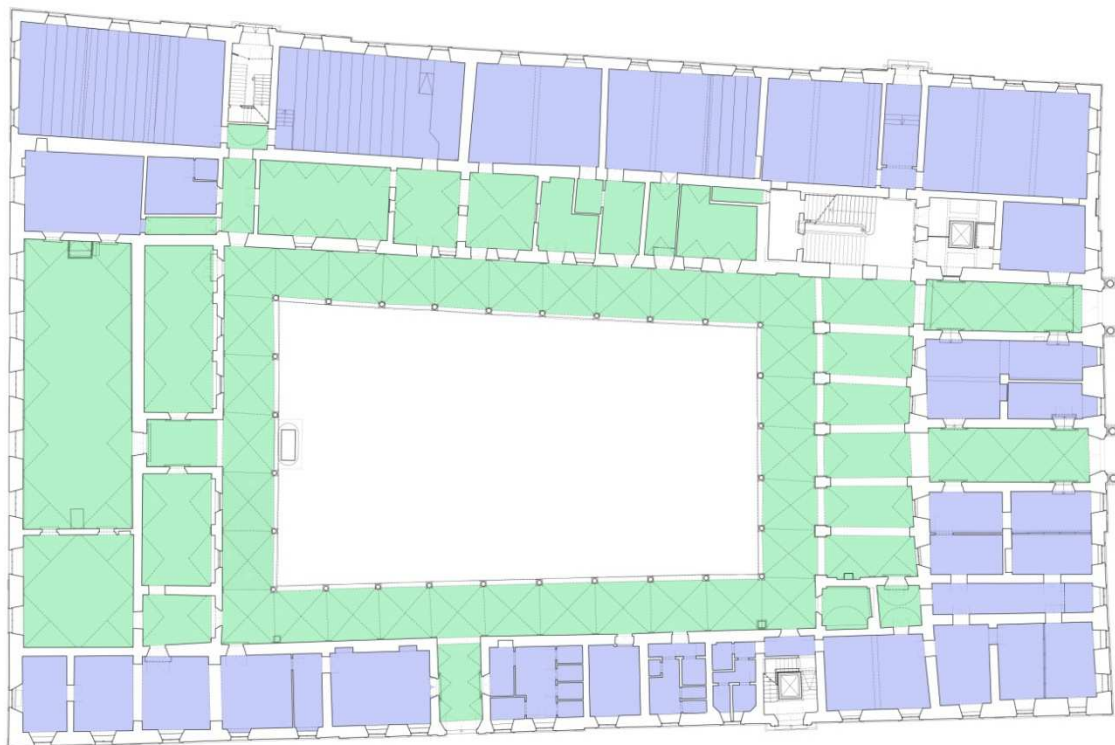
Pianta piano secondo. Classificazione delle strutture murarie.
